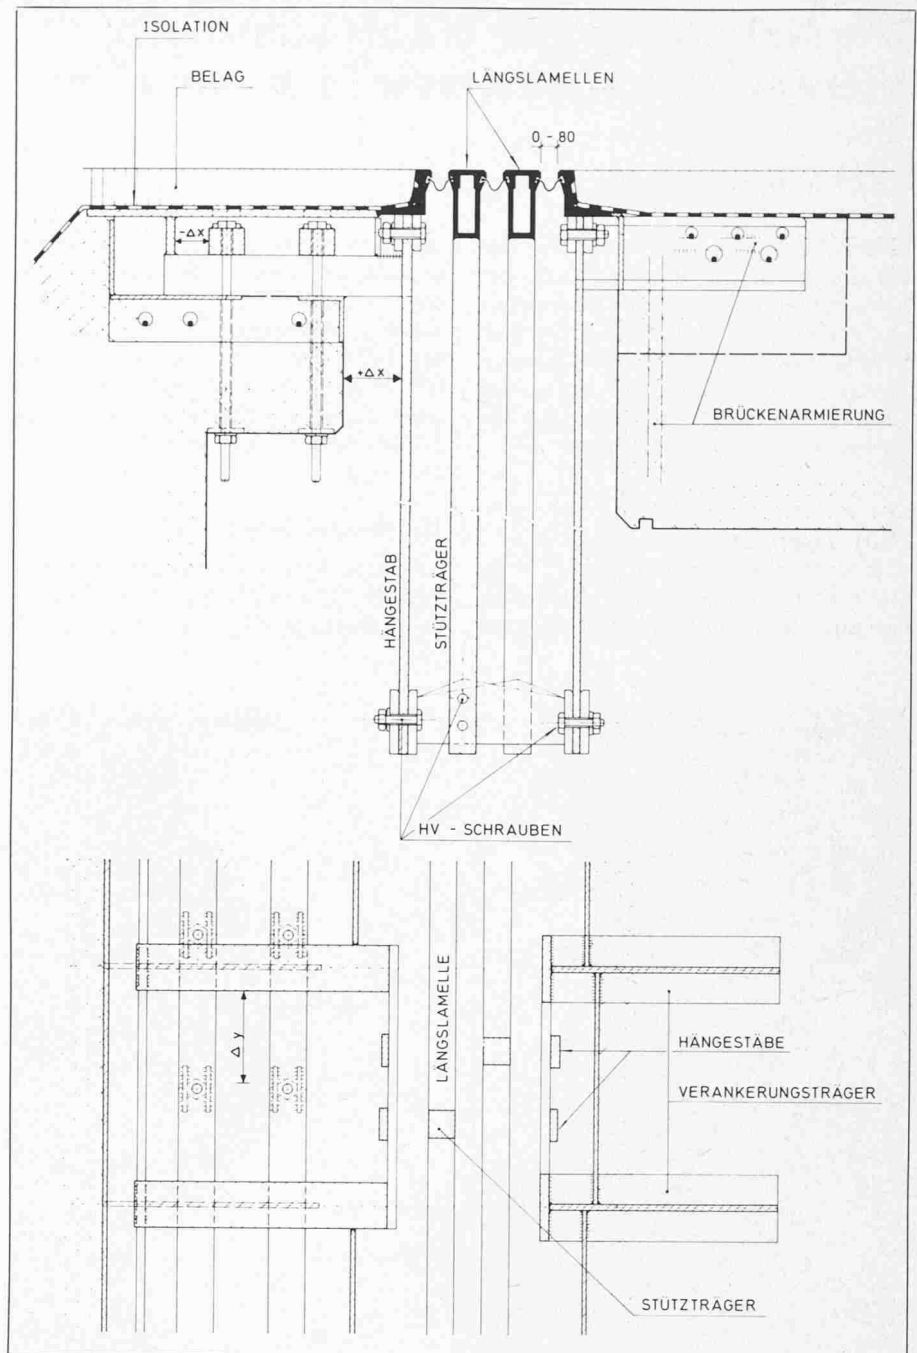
Fahrbahnübergang WL 1 mit Vorrichtung zum Nachstellen allfälliger Hangbewegungen. Oben: Querschnitt mit den eingetragenen Nachstellmöglichkeiten. Unten: Grundriss oben mit den eingetragenen Nachstellmöglichkeiten
